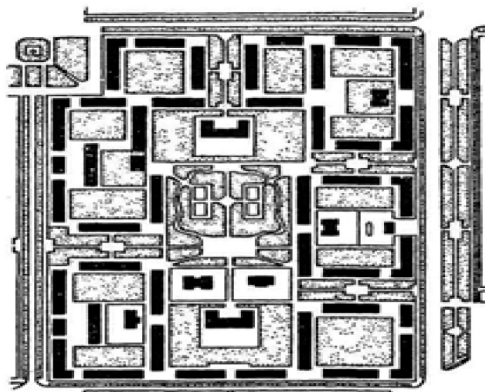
Планувальне рішення житлового району з груповим розміщенням будівель
